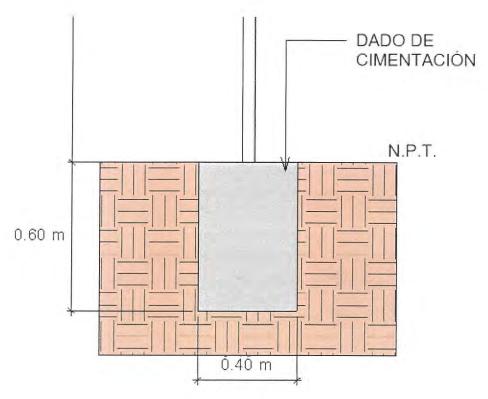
Detalle en corte de dados de cimentación para señalización vertical.
